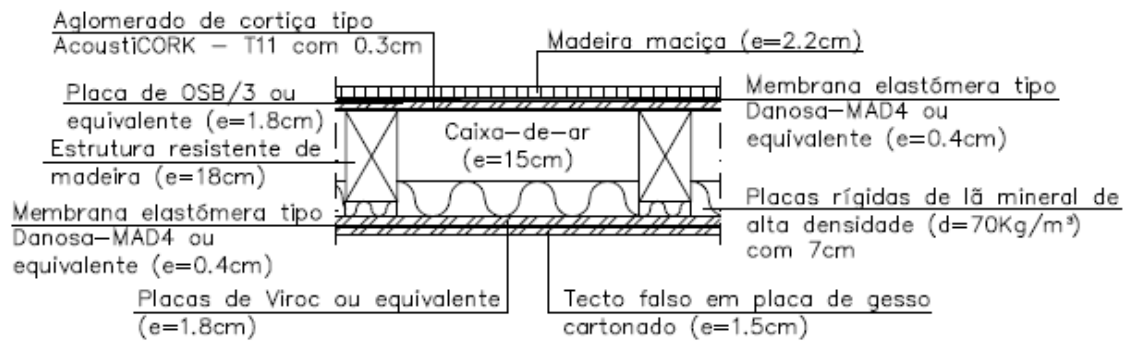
Pormenor construtivo do pavimento (Projeto de CT)
